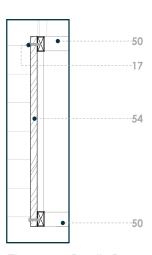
Detalle D-08 Esc 1:10. Fuente: Autores, 2024
